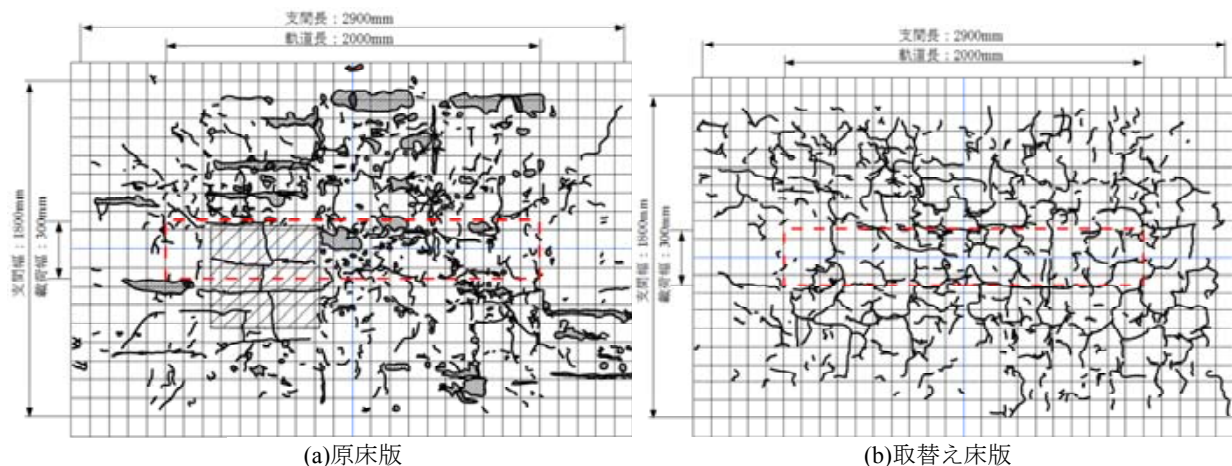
疲労限界状態時における下面ひび割れの発生状況
